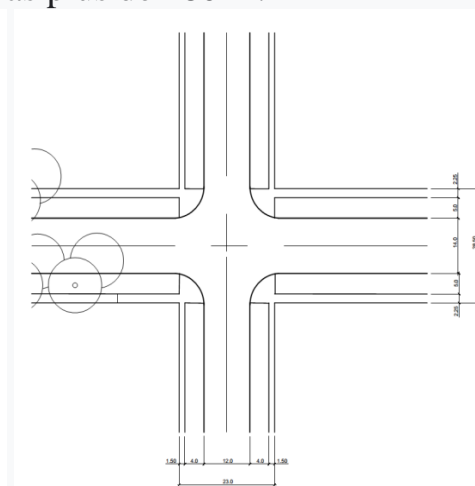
Éléments de rue et d'intersection sur le dessin en plan.
